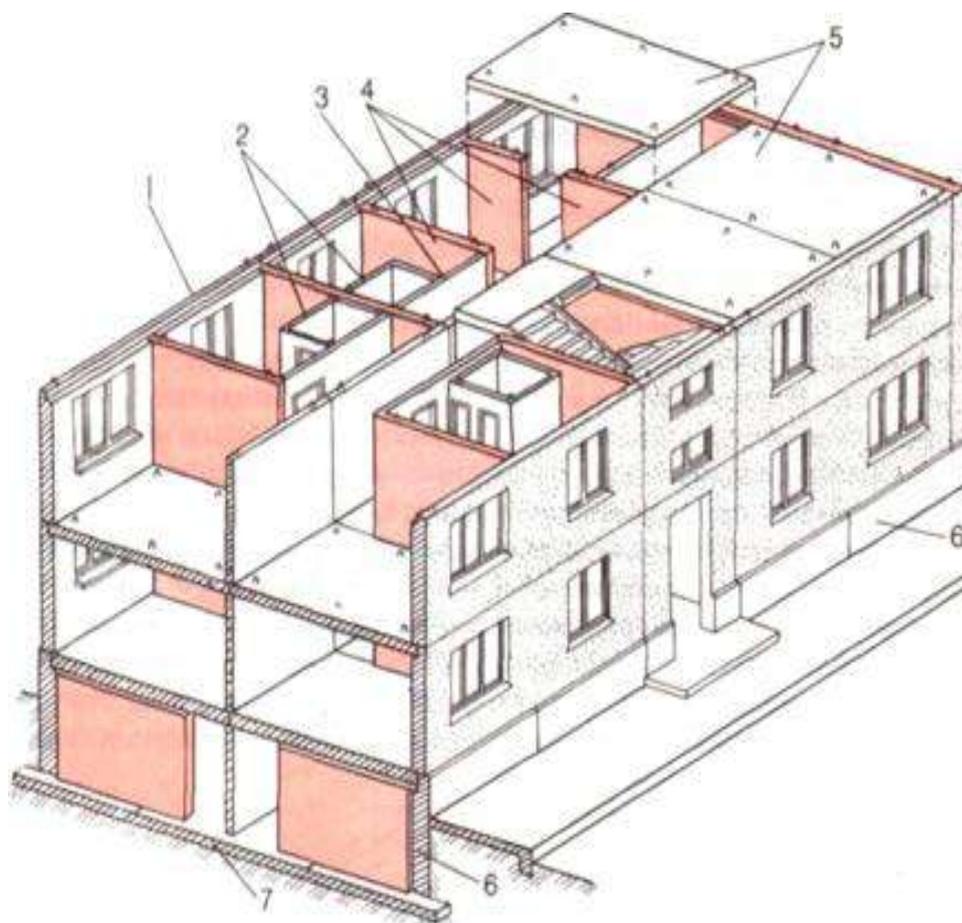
Конструктивная схема крупнопанельного дома с несущими стенами
